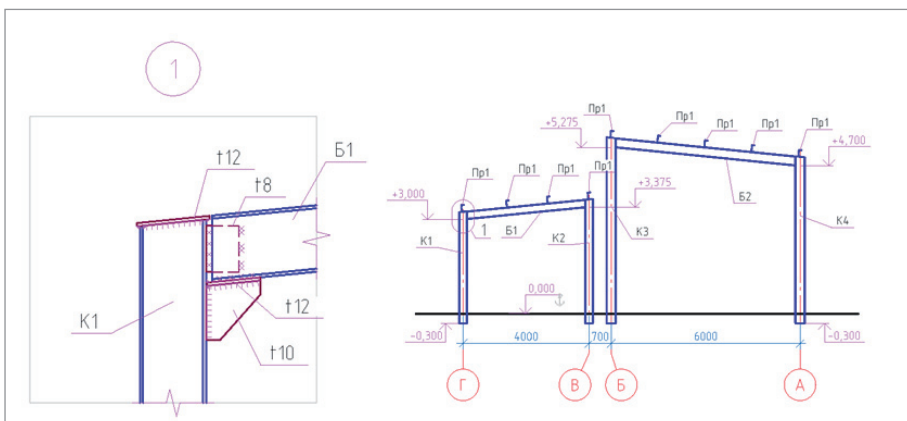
Добавление сварных швов в узле и высотных отметок на разрезе
